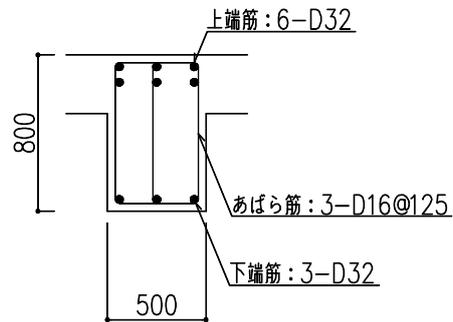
大ばりの配筋図（地下1階，YC通り X33～X34通り間，端部）（単位：mm）
